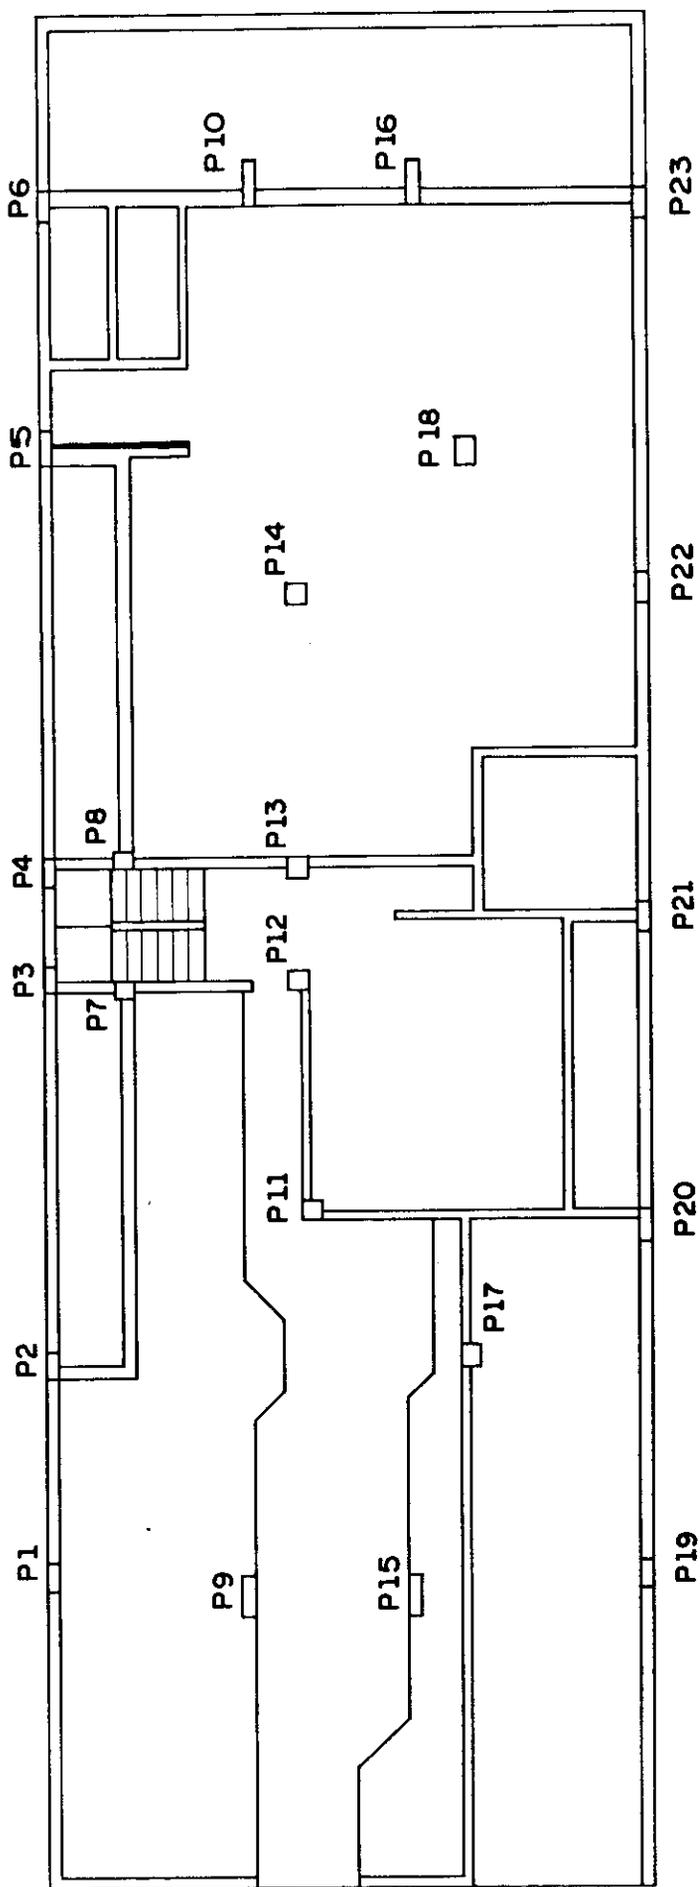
a - Estrutura I - Pavimento Tipo Edifício B
